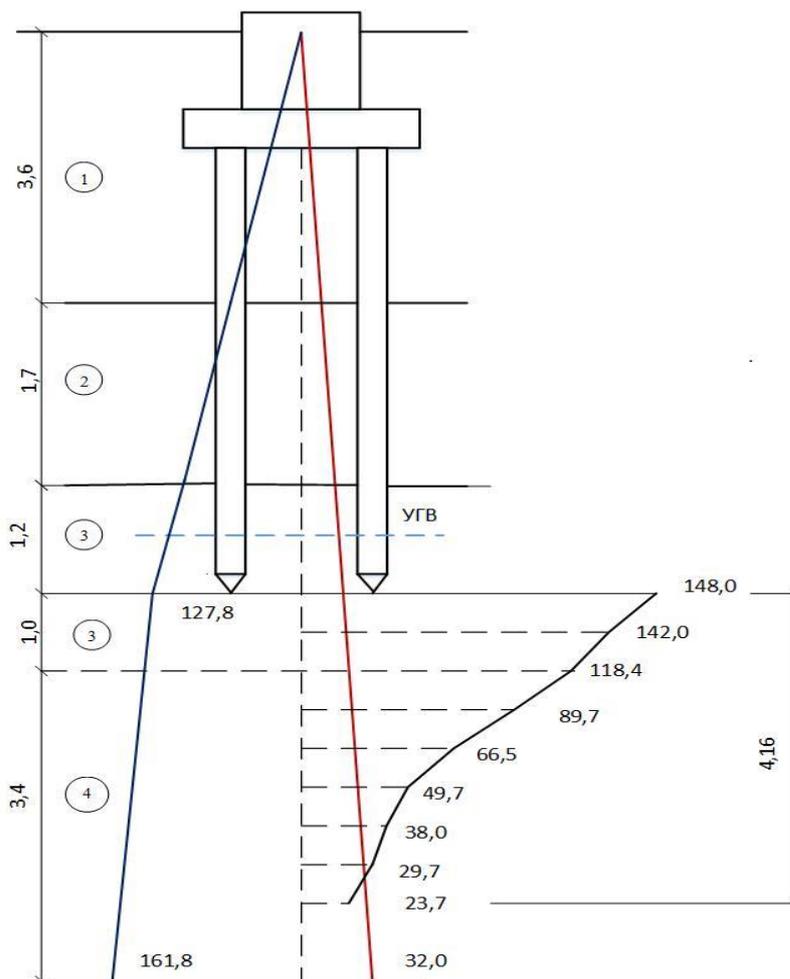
Расчетная схема к определению осадки фундамента
